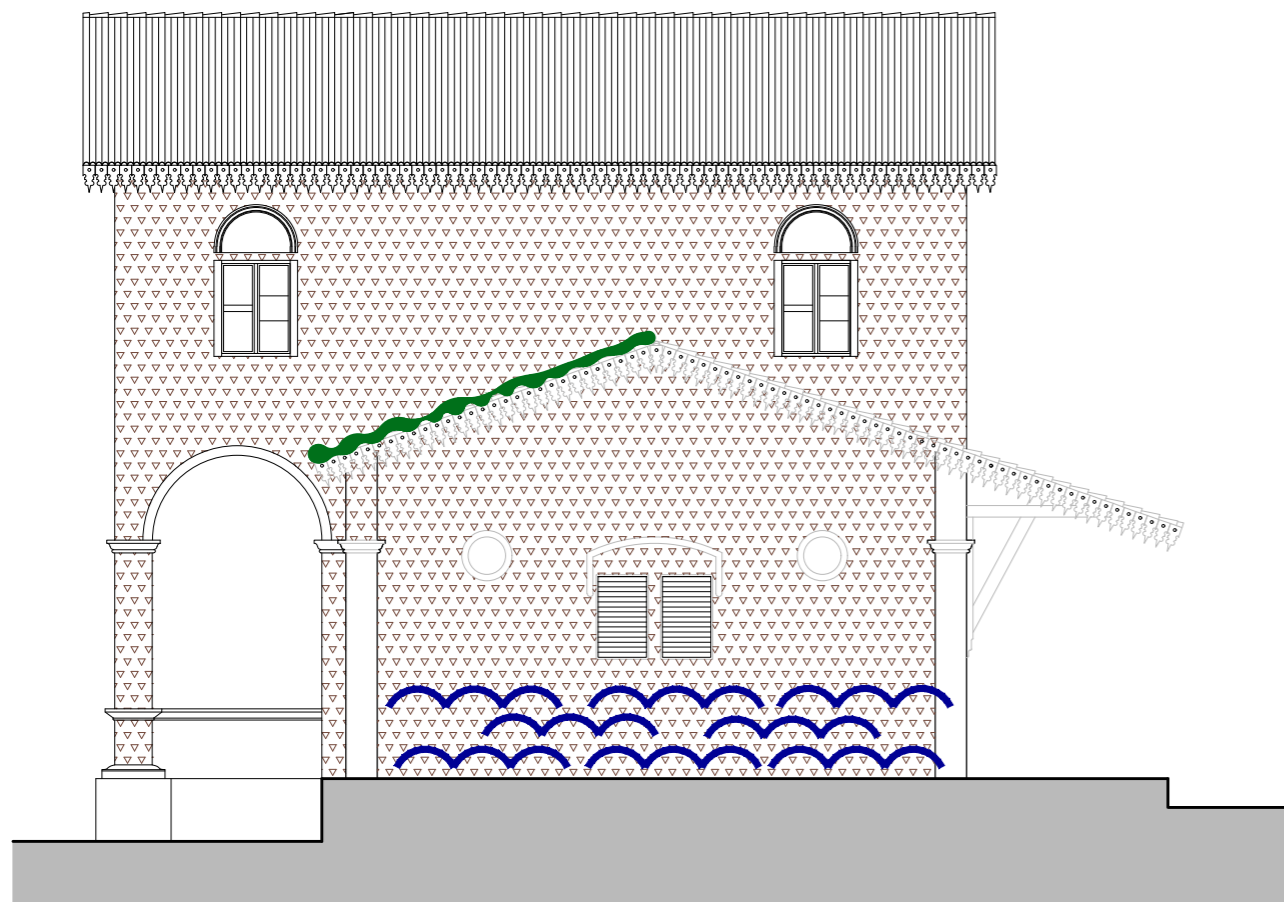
Telhado da fachada Oeste. Fonte: Acervo pessoal.
